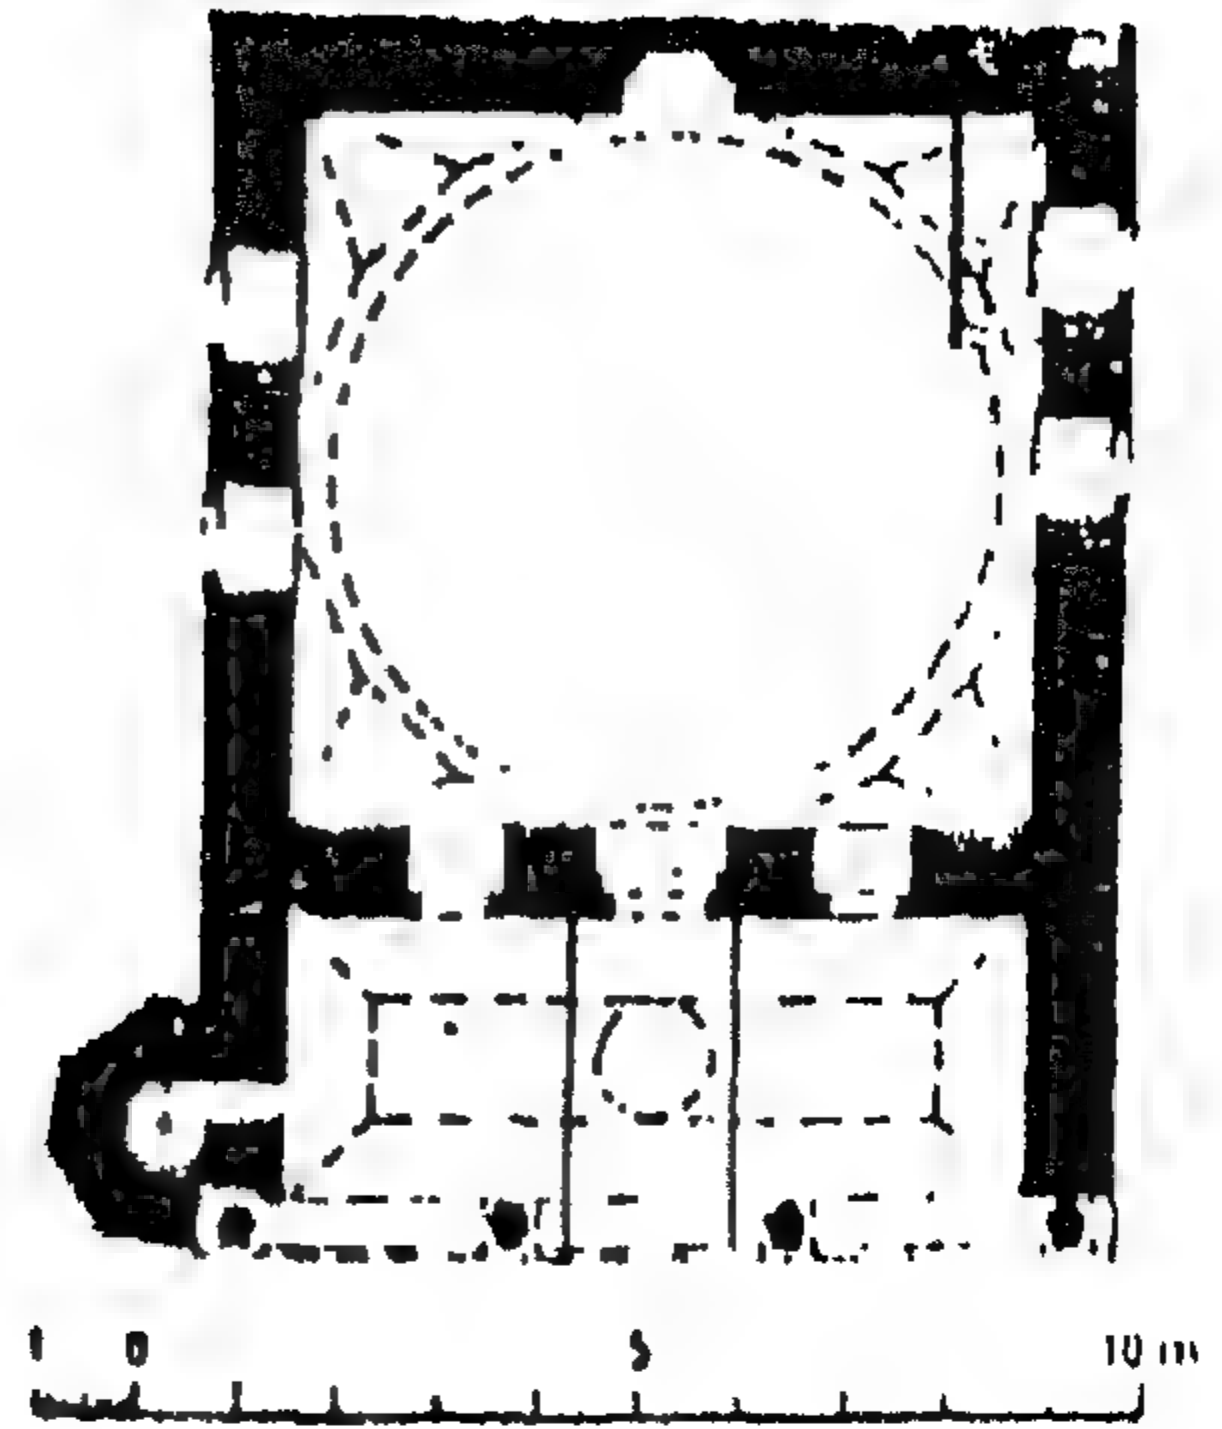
مسقط أفقي لمسجد طاش بقونية (عن : Aslanapa) .
